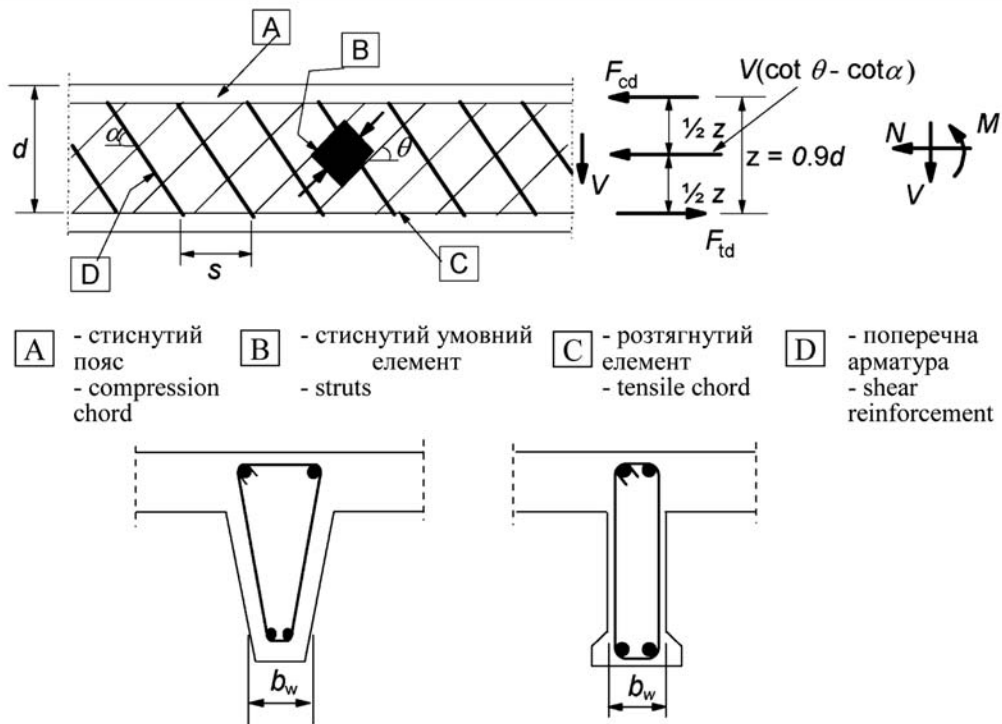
Фермова модель і позначки для елементів поперечного армування
